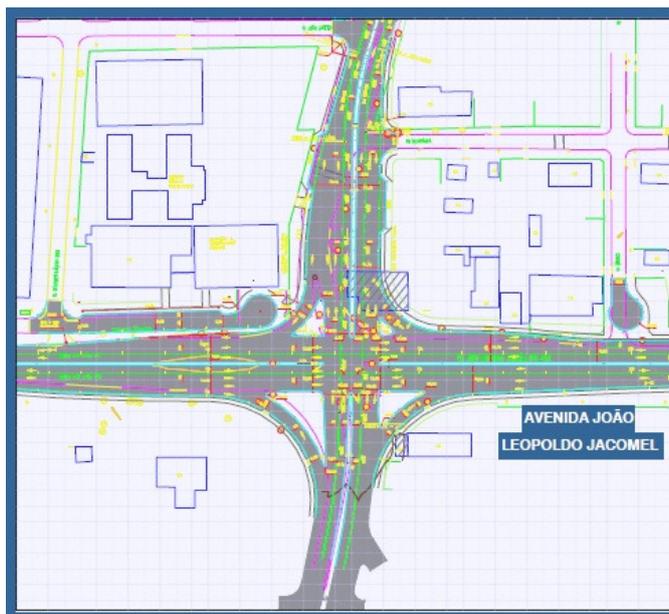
PIT RMC – PROJETO AV. JACOB MACANHAN
